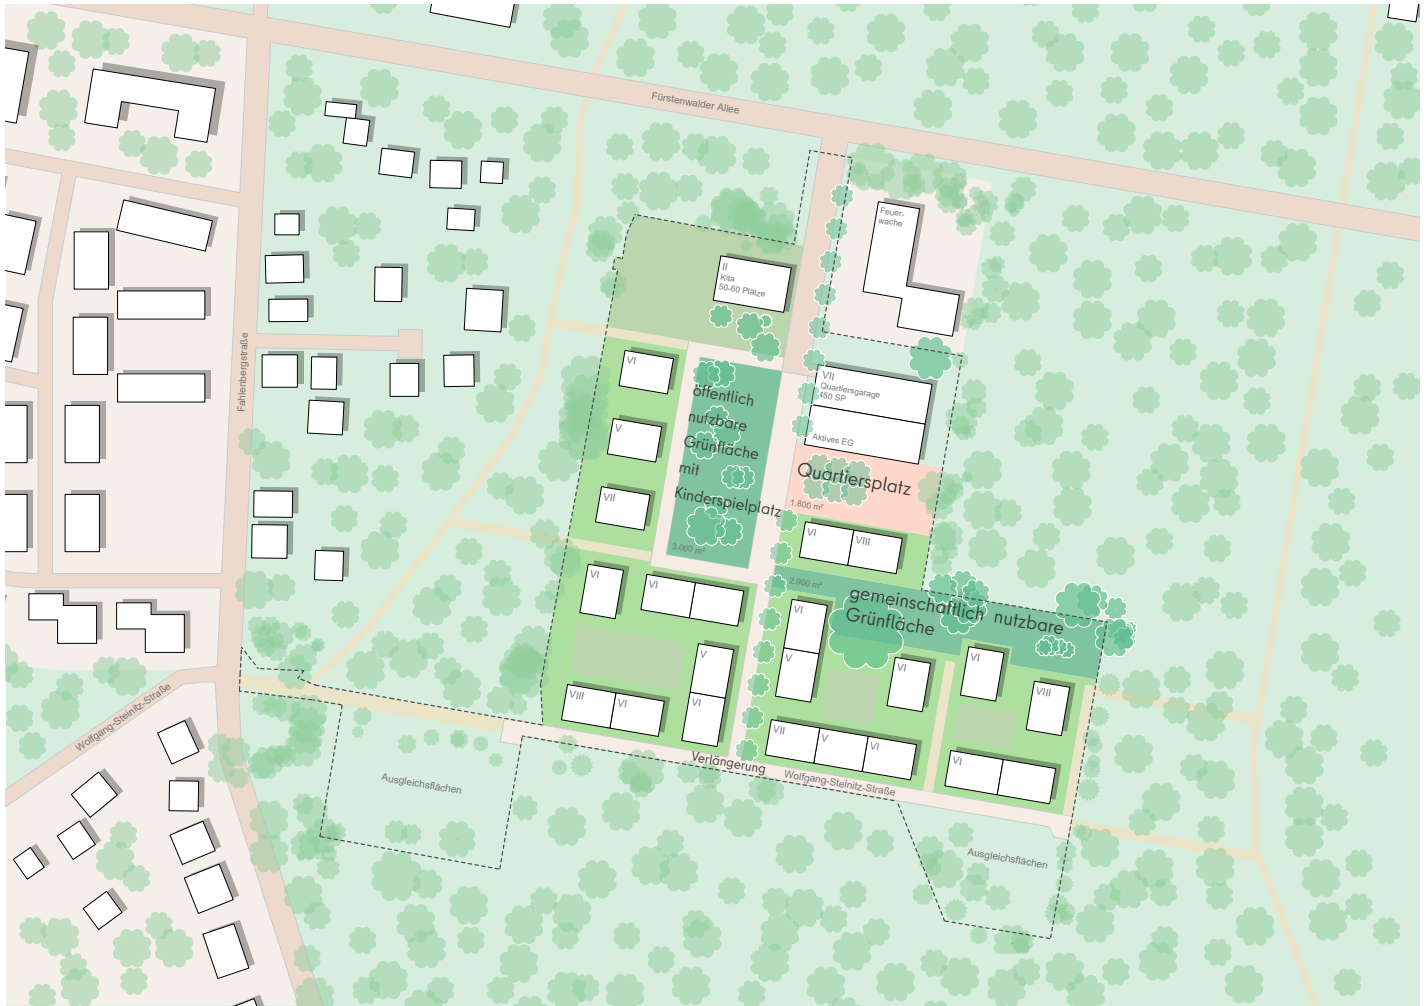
Städtebaulicher Entwurf, Machleidt GmbH 2024
